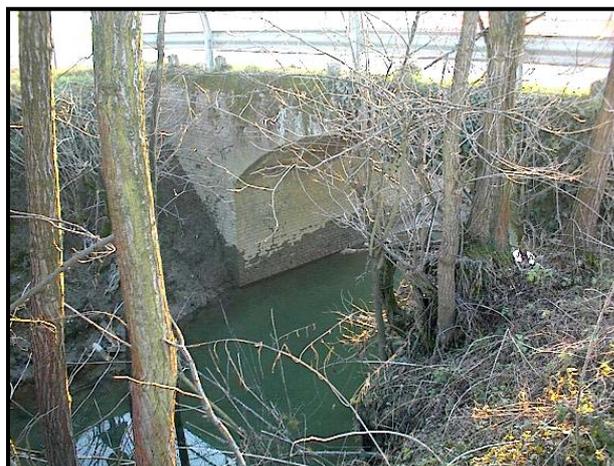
Vista da valle dell'attraversamento del t. Rotaldo lungo la strada per S. Maurizio.
